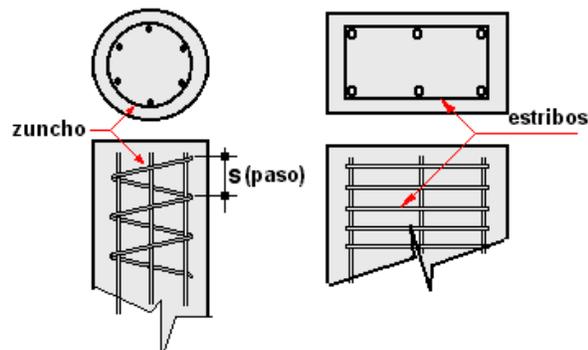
Confinamiento de columnas de concreto. Fuente: Clases de Concreto reforzado Universidad Católica Andrés Bello. Caracas. (2006)
